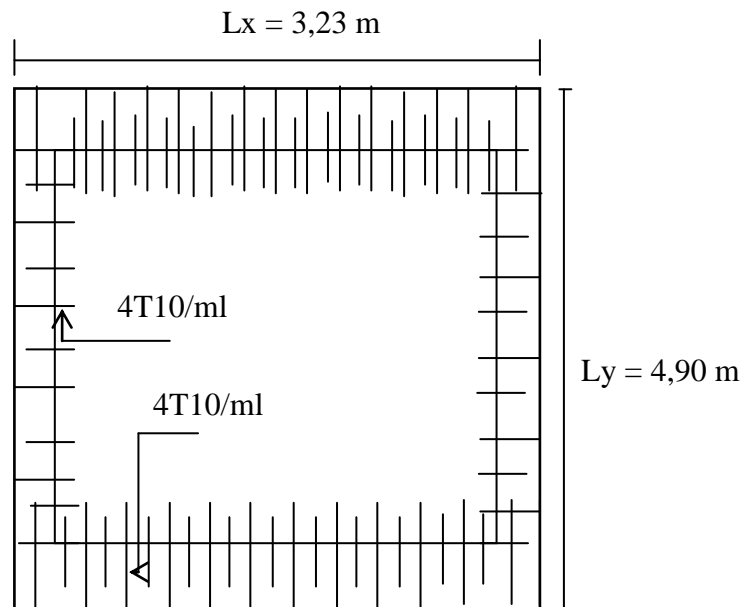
Dessin Ferrailage Supérieur du panneau de la dalle pleine.
